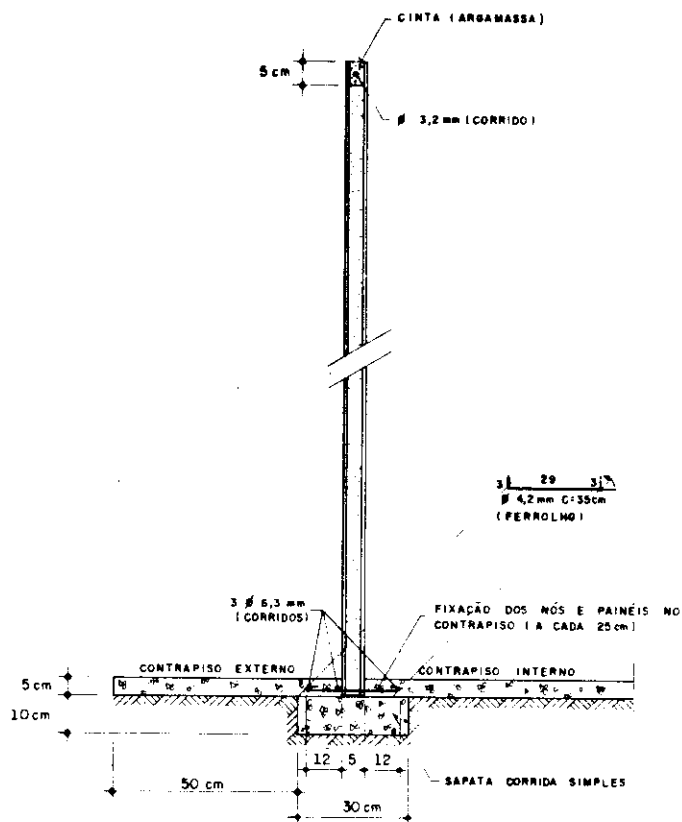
DETALHE DA FIXAÇÃO DOS PAINÉIS E ELEMENTOS DE LIGAÇÃO NO CONTRAPISO E CINTA DE AMARRAÇÃO SUPERIOR.
